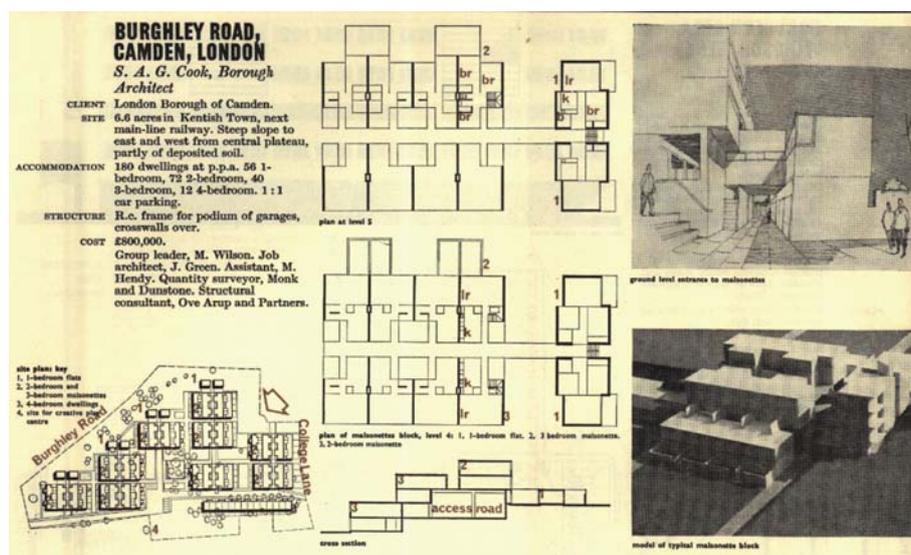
Burghley Road*. Planimetria generale, piante tipo, particolare assometrico e modello, tratti dalla rivista *Architectural Review* N.839 gennaio 1967
